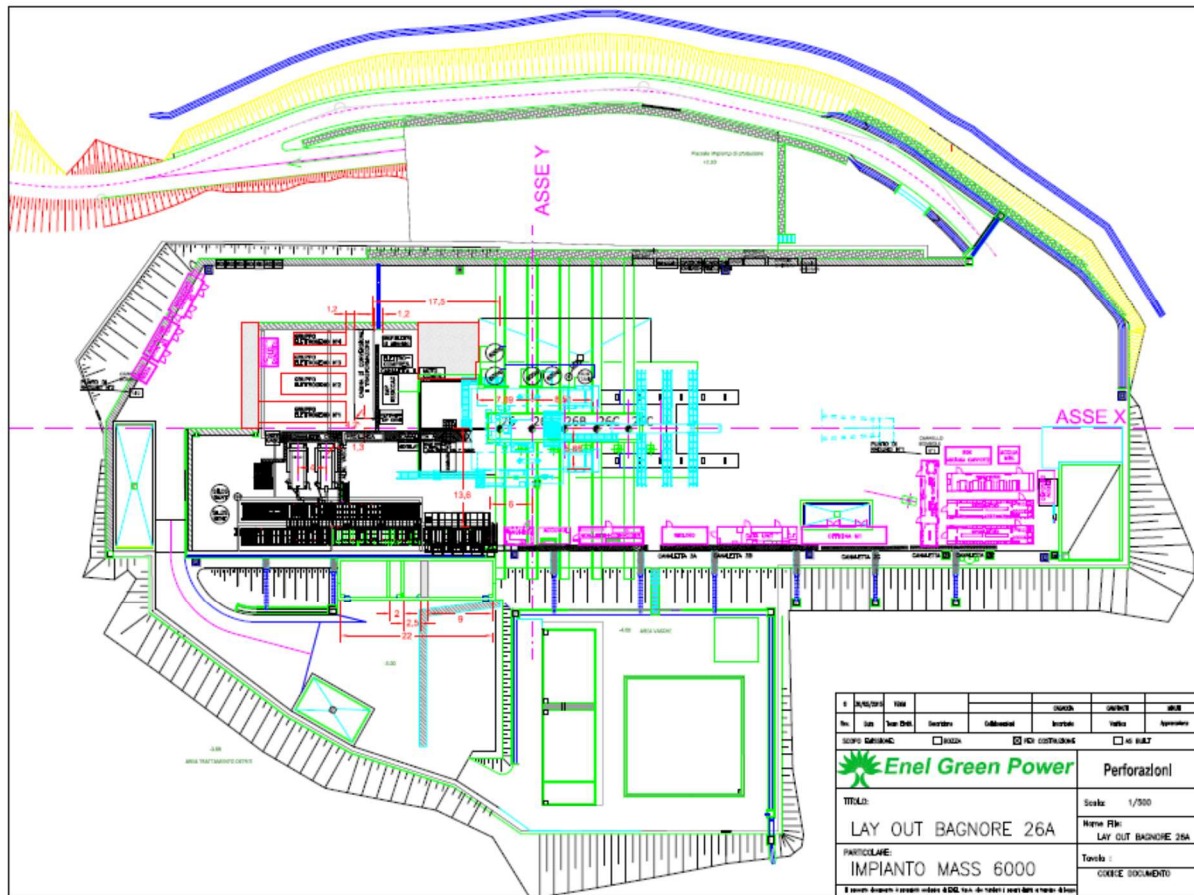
Planimetria postazione di perforazione standard per impianto MAS 6000E
